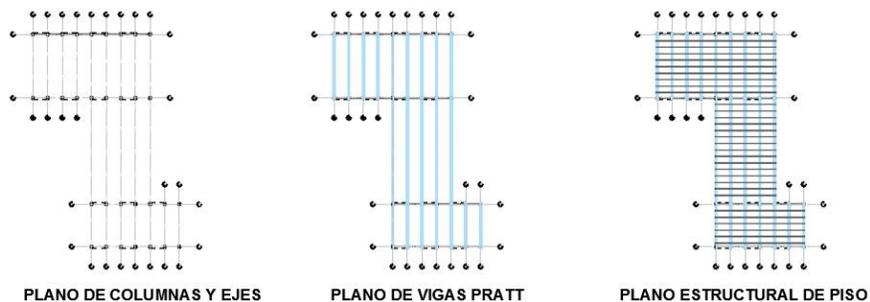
Planos Esquema de Vigas Pratt, Contorno y Correas
